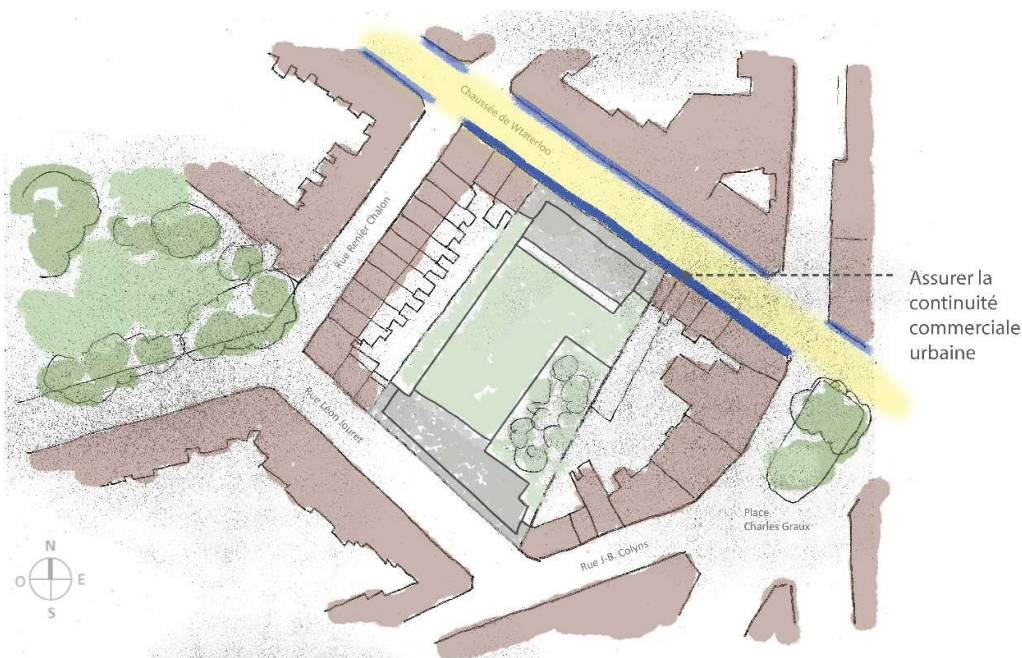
Plan schématique de l'implantation des fonctions actives en rez-de-chaussée
